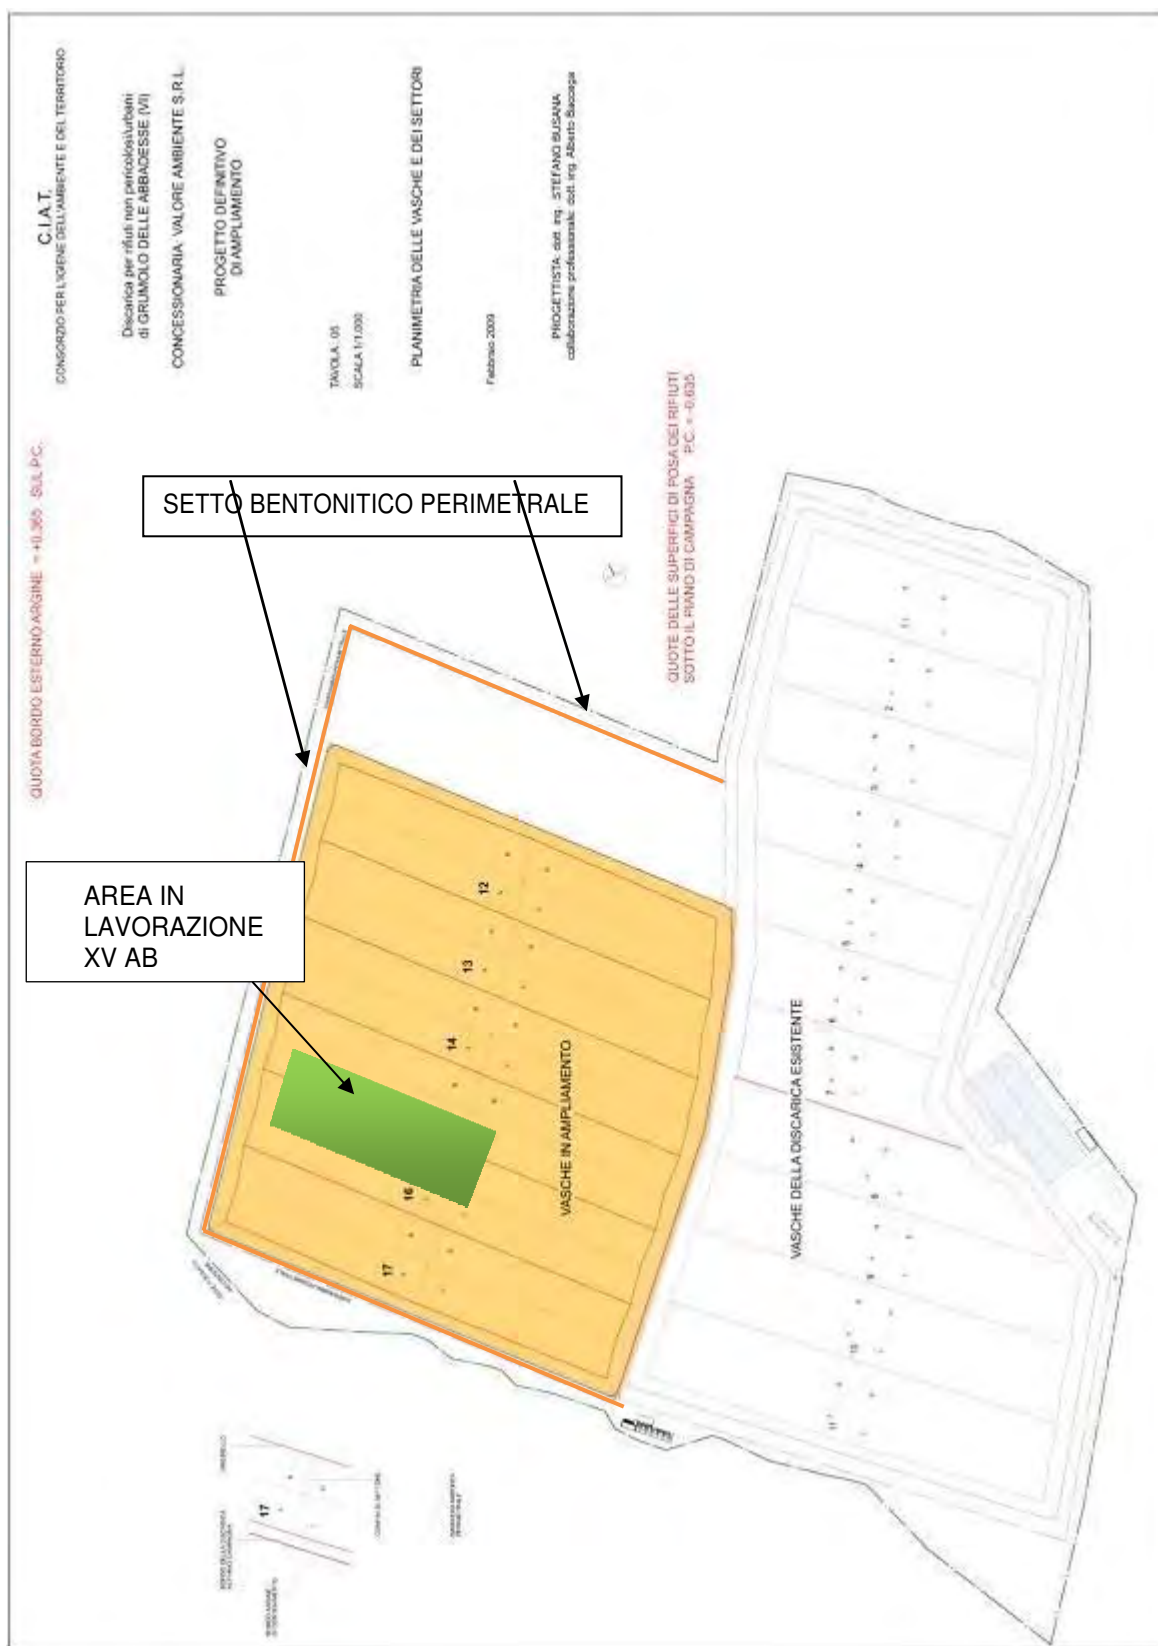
planimetria dello stato di avanzamento lavori di approntamento vasche
